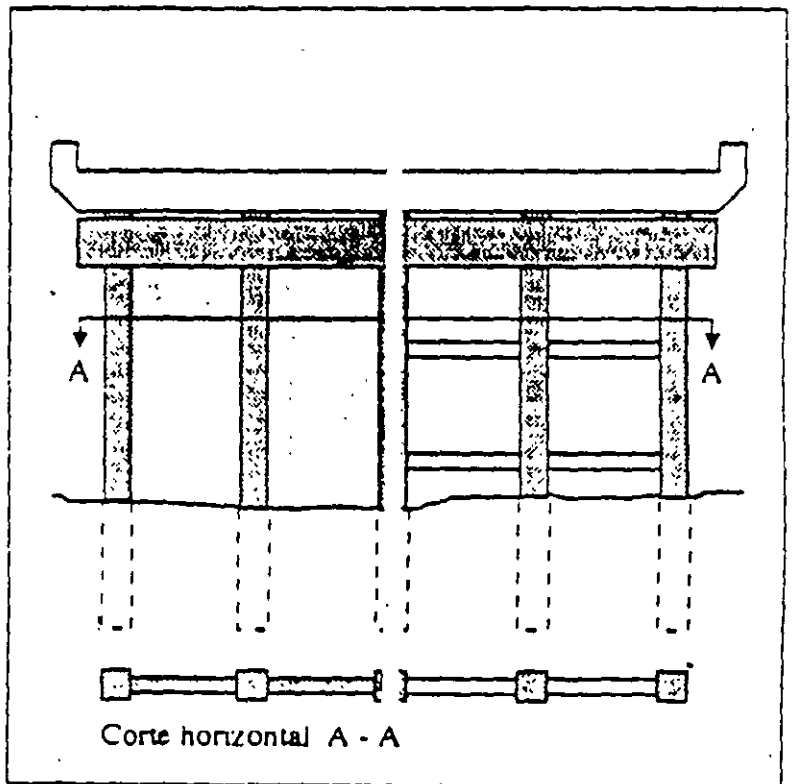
Pila, tipo 41, pilotes con cabezal y diafragma (o vigas horizontales)
